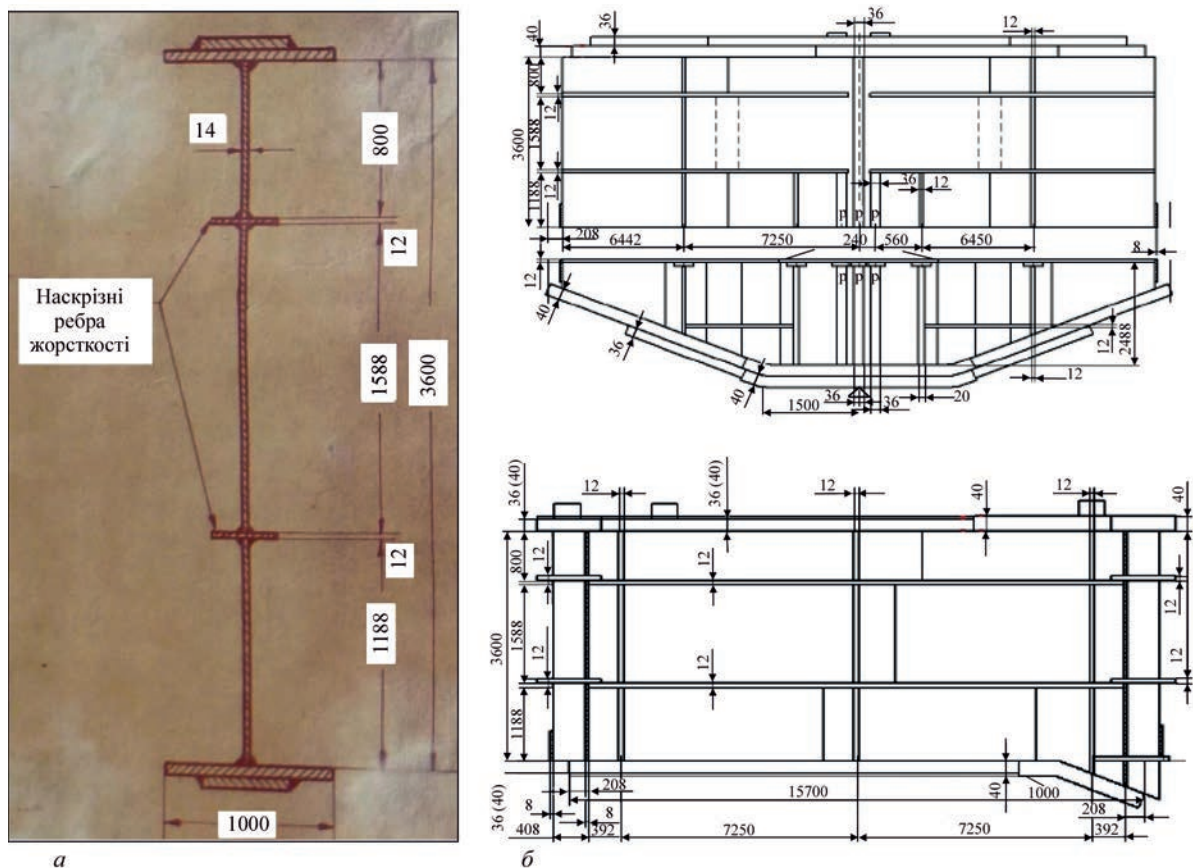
Поперечний переріз головної поздовжньої балки двотаврового перетину (*a*) і креслення фрагментів головної поздовжньої двотаврової балки (*б*)
